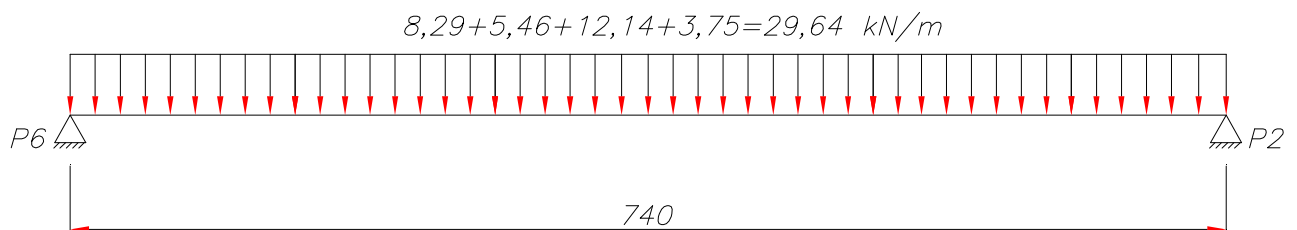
Modelo Estrutural e Carregamento Viga V6
